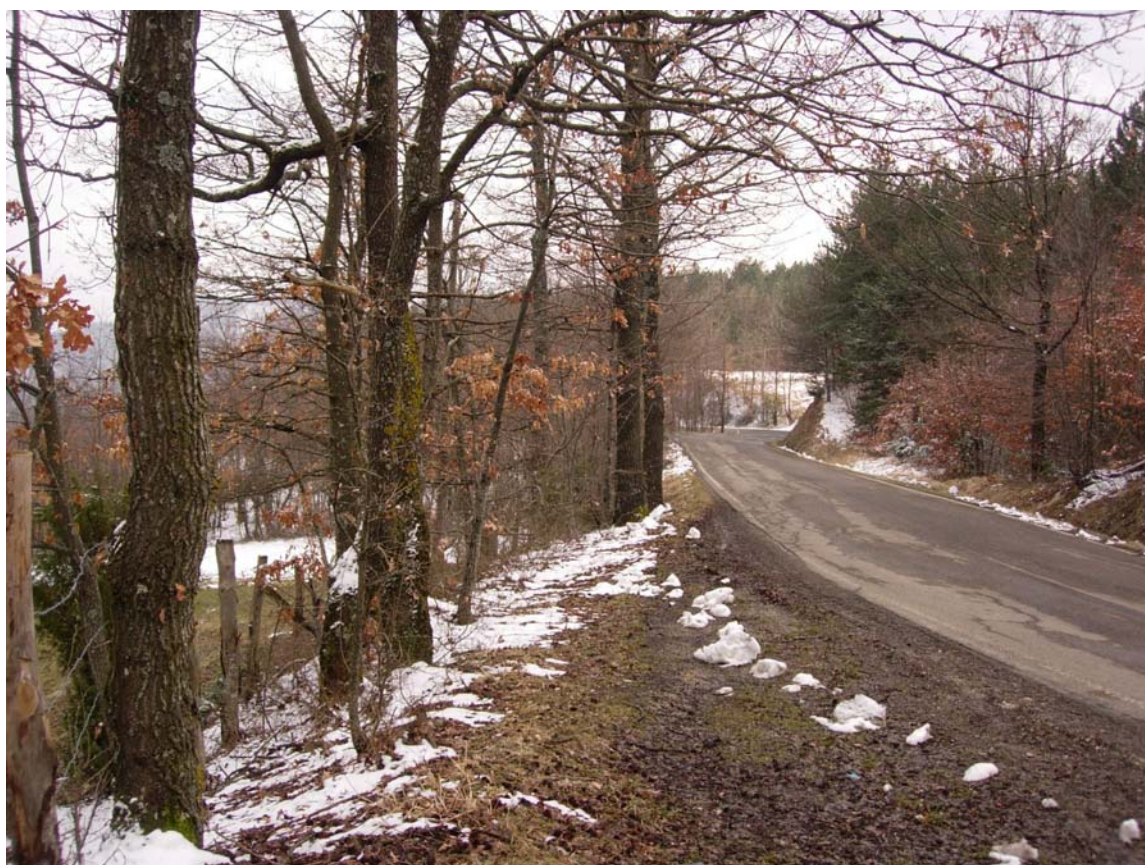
/B: Vista della SP Sestinese, nel tratto di collegamento fra l'alternativa ed il tracciato di progetto.
